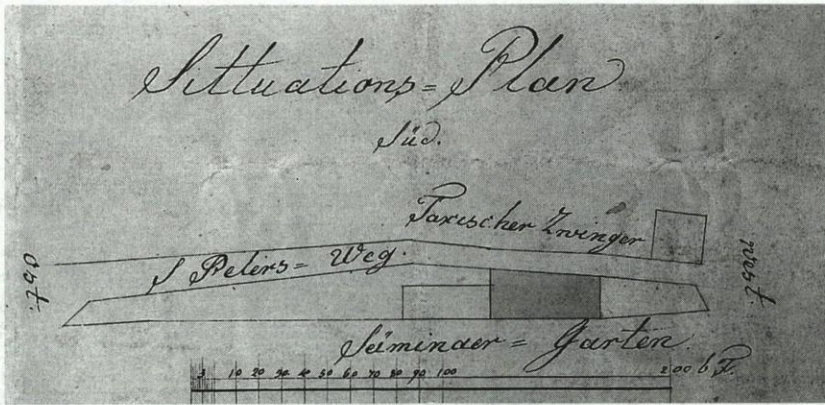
St. Peters-Weg 9, Lageplan 1834 (BOAR).
